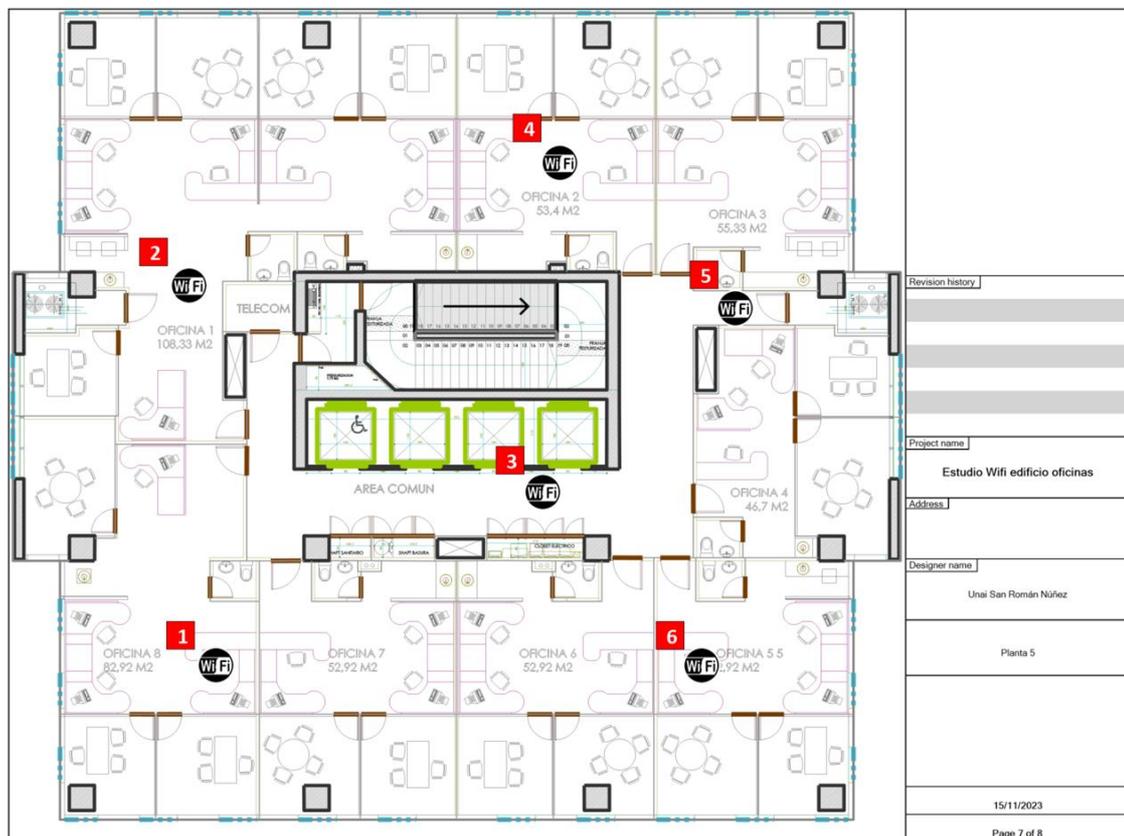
Posicionamiento Puntos de Acceso. Planta 5.
